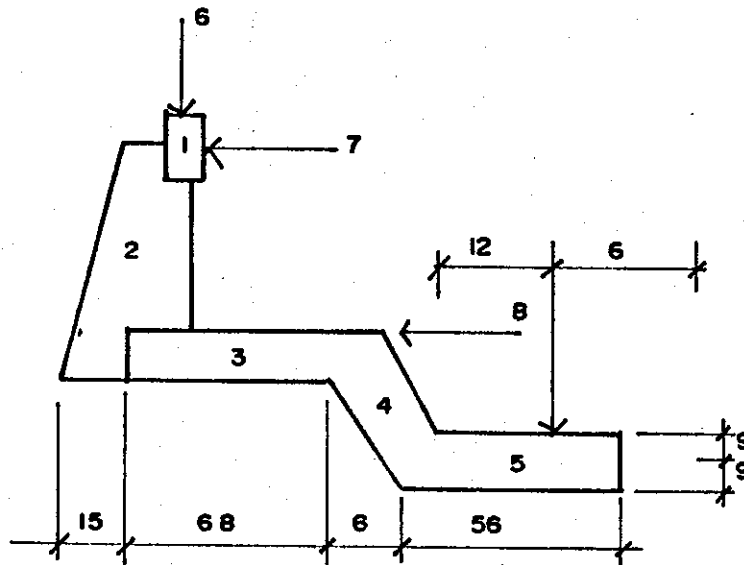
SECCIÓN DE LOSA EN VOLADIZO
